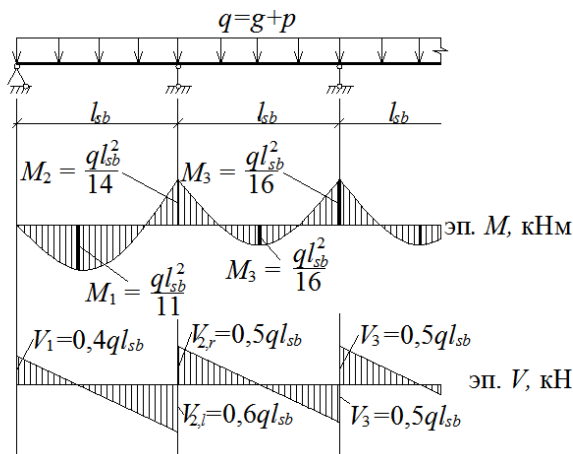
Расчетная схема и эпюры изгибающих моментов и поперечных сил второстепенной балки
